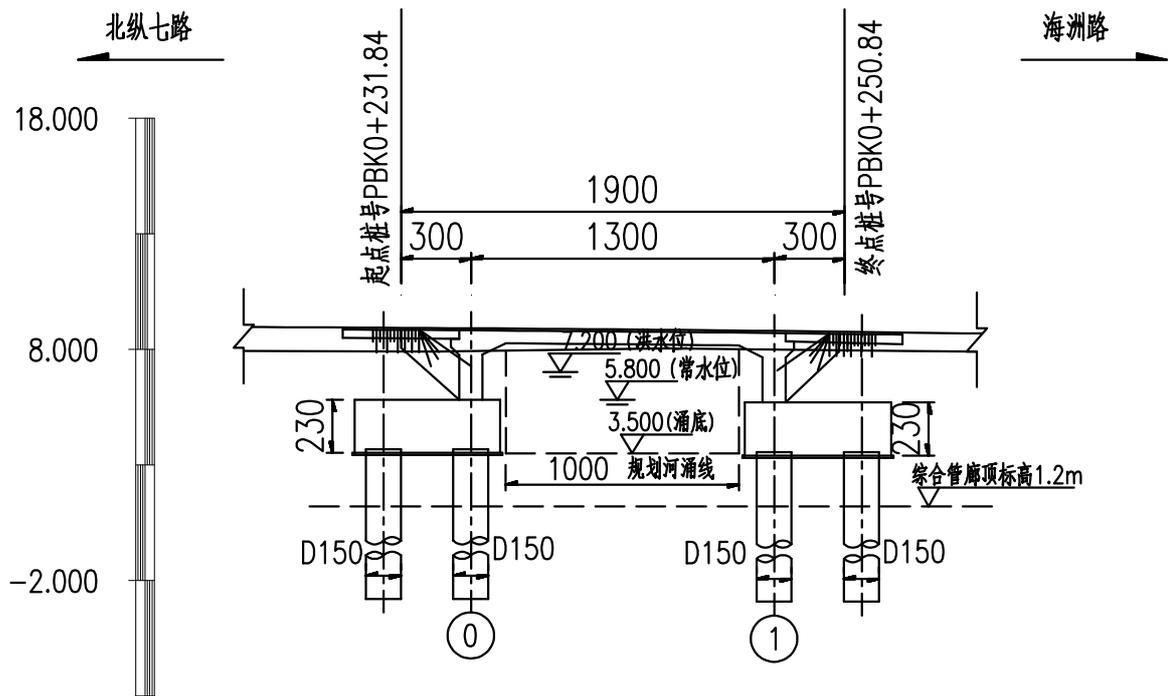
琶洲北大街小桥立面图 (单位: cm)
